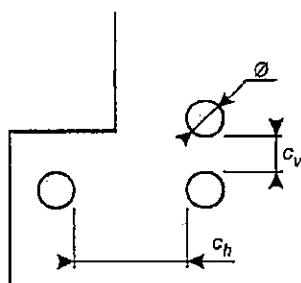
Posizionamento delle barre di armatura (misure in mm)
